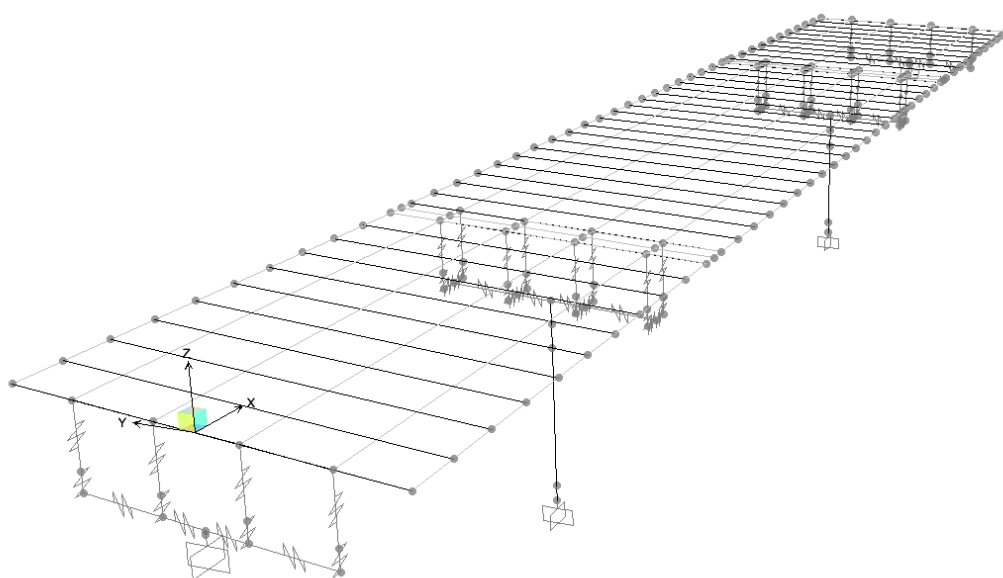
Modello di calcolo: con elementi shell soletta non in vista
